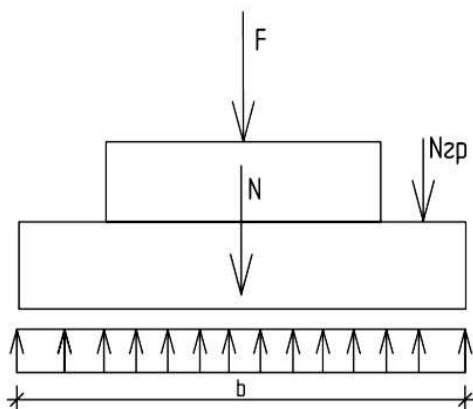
Расчетная схема столбчатого фундамента.
